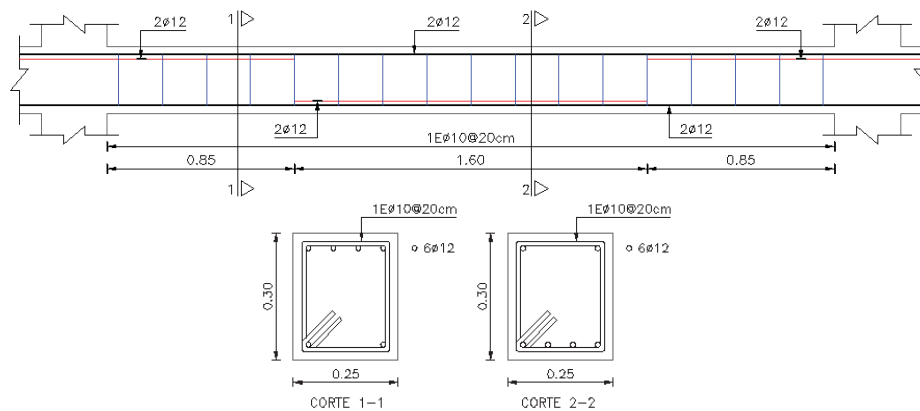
Armadura vigas interiores (Ejemplo de aplicación)
